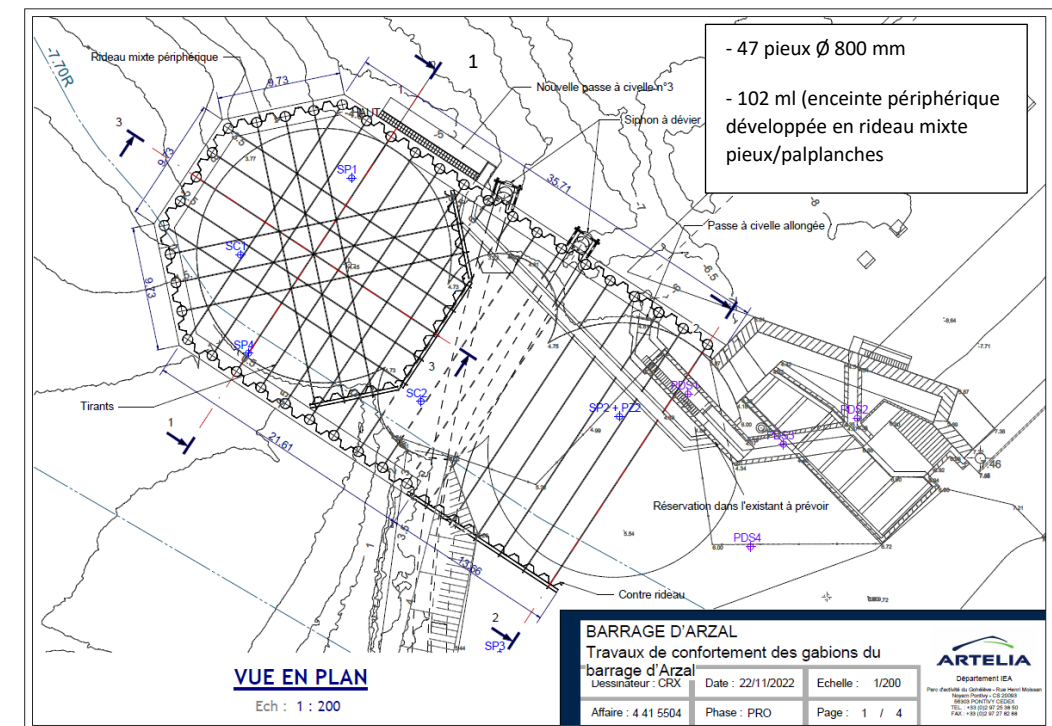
Exemple de chantier de type combiwall (pieux + palplanches)
